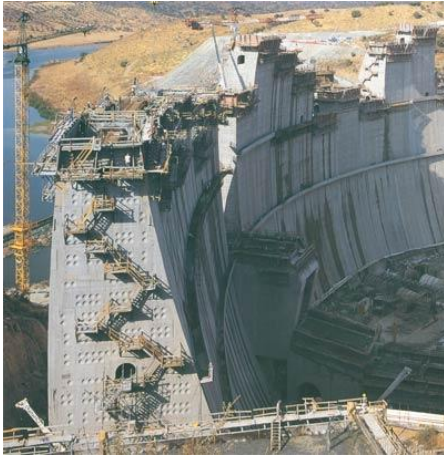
Construção da barragem do Alqueva em Portugal (PERI s.d.).
